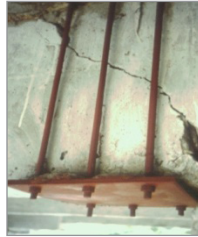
Grieta a cortante en viga principal de concreto reforzado
